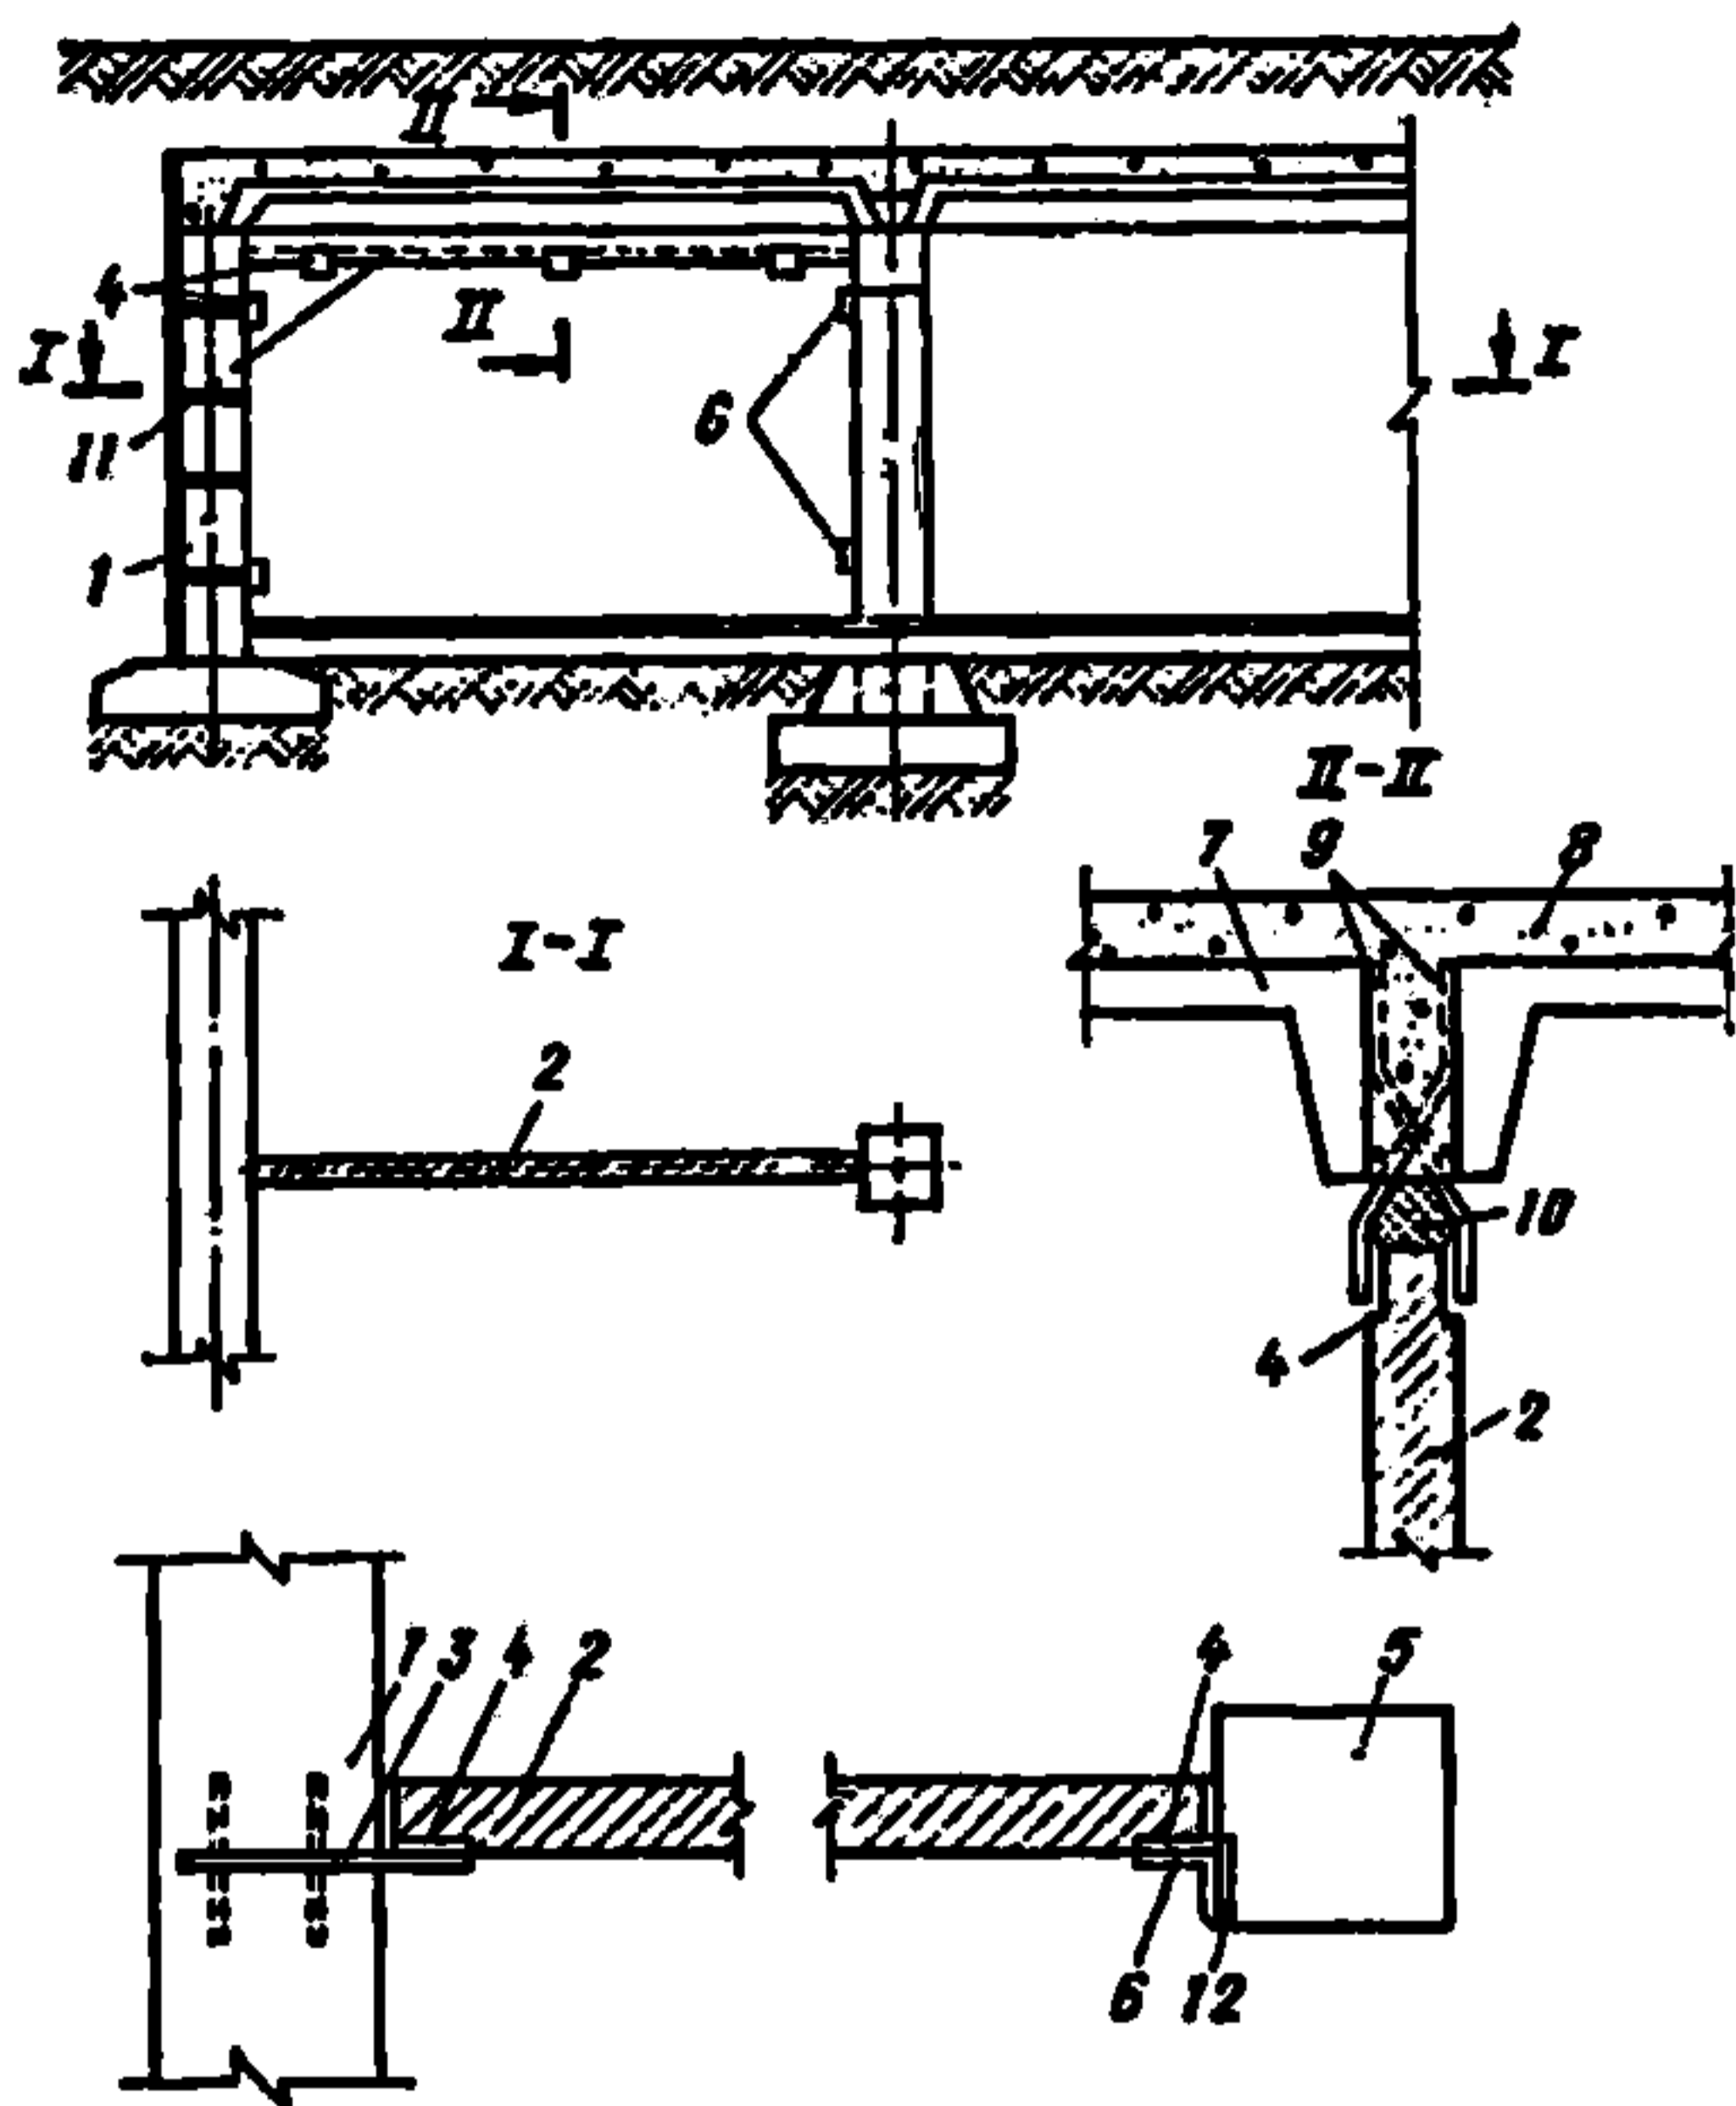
Конструктивное решение крепления сборной железобетонной перегородки
